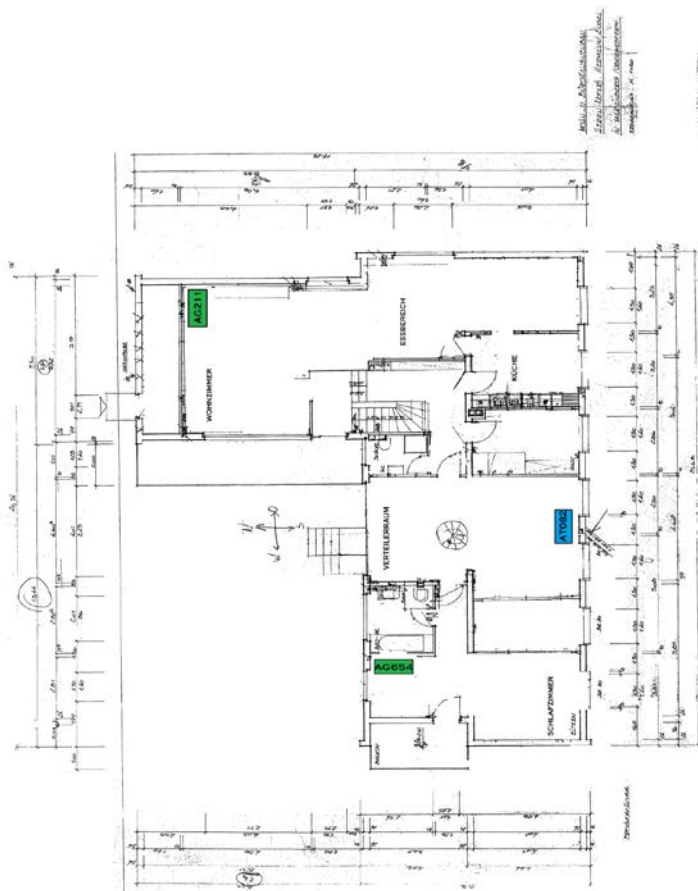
Grundriss des Erdgeschosses mit Wohnzimmer (ebenerdig) und Verteilerraum (Zwischenetage).
